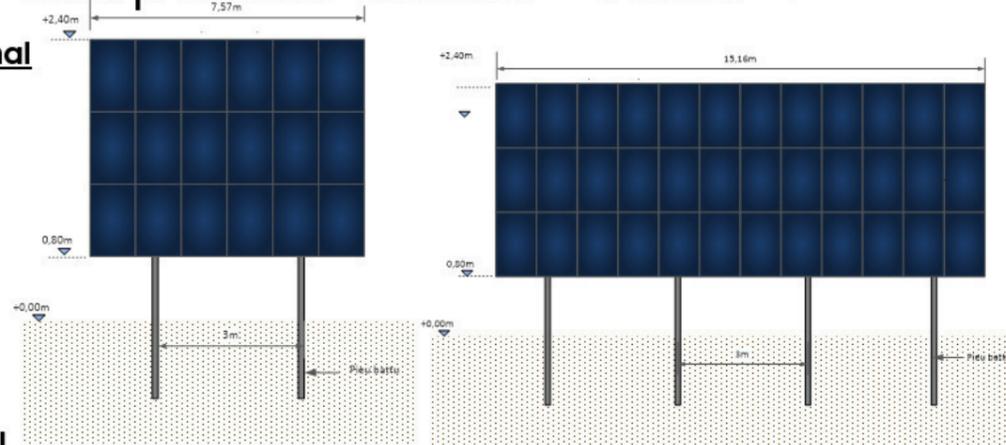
Plan en coupe des tables : casiers 1-2-3
